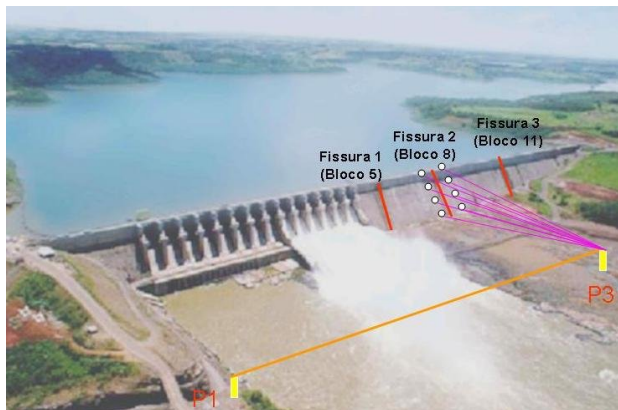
Monitoramento das Fissuras a Jusante
